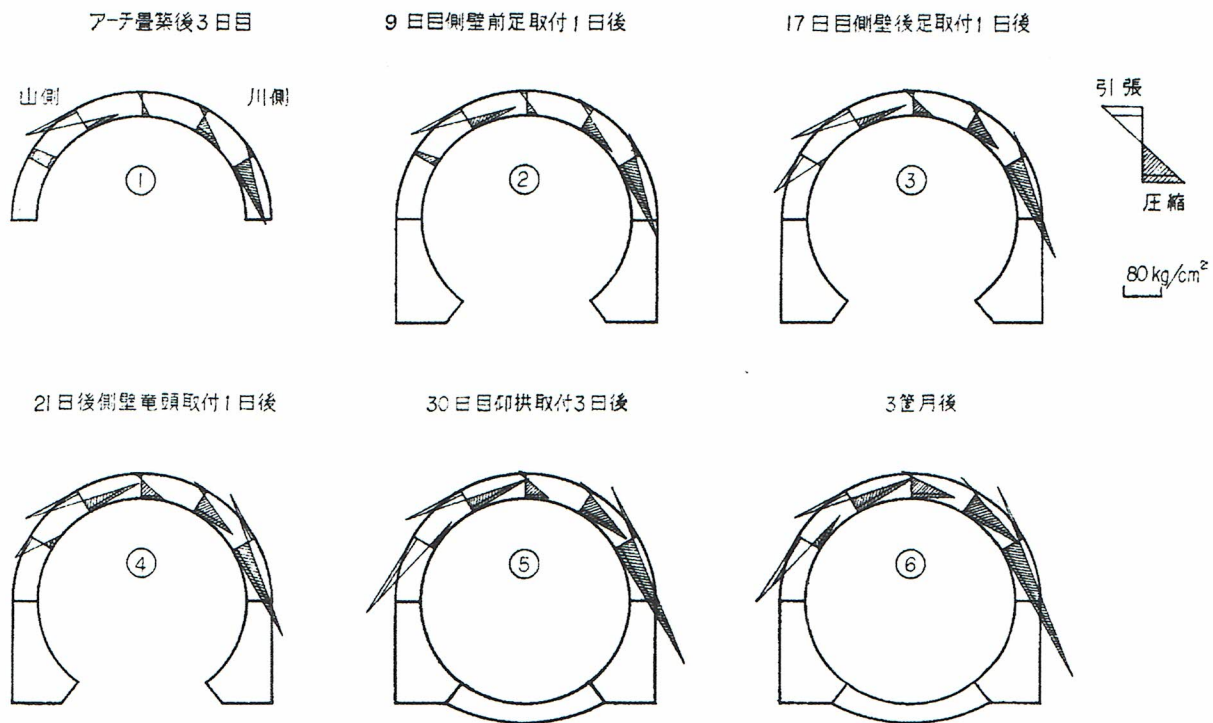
穹拱コンクリート応力分布図 (カールソンヒズミ計)
